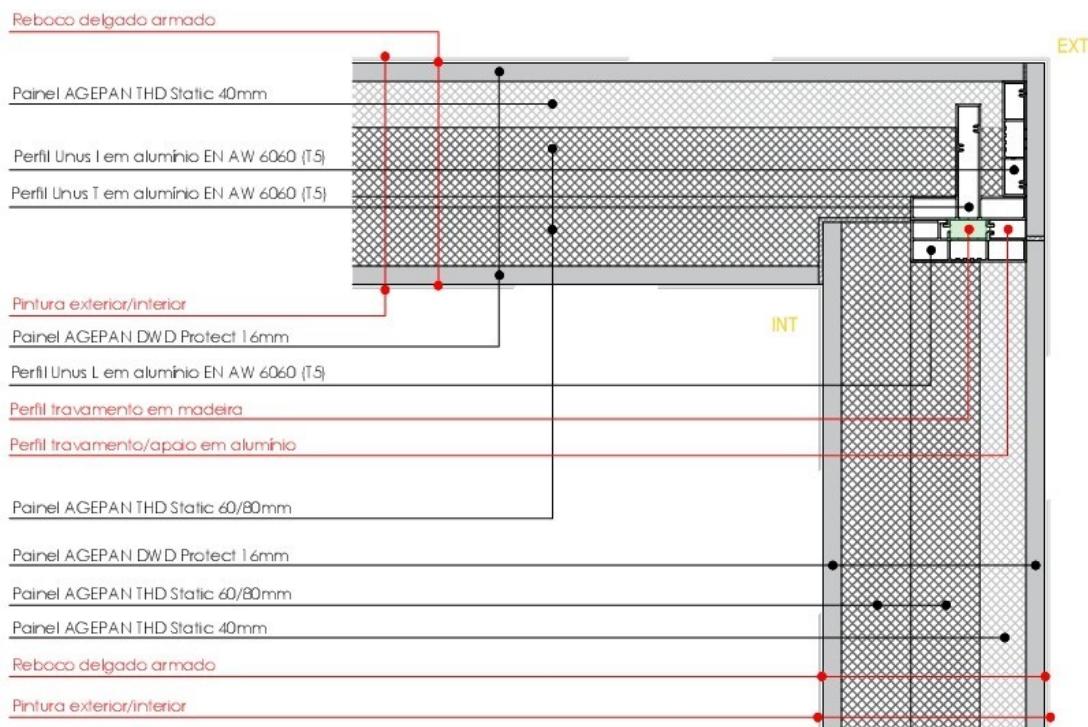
Solução AGEPLAN – Pormenor Construtivo de Canto de Paredes Verticais.
